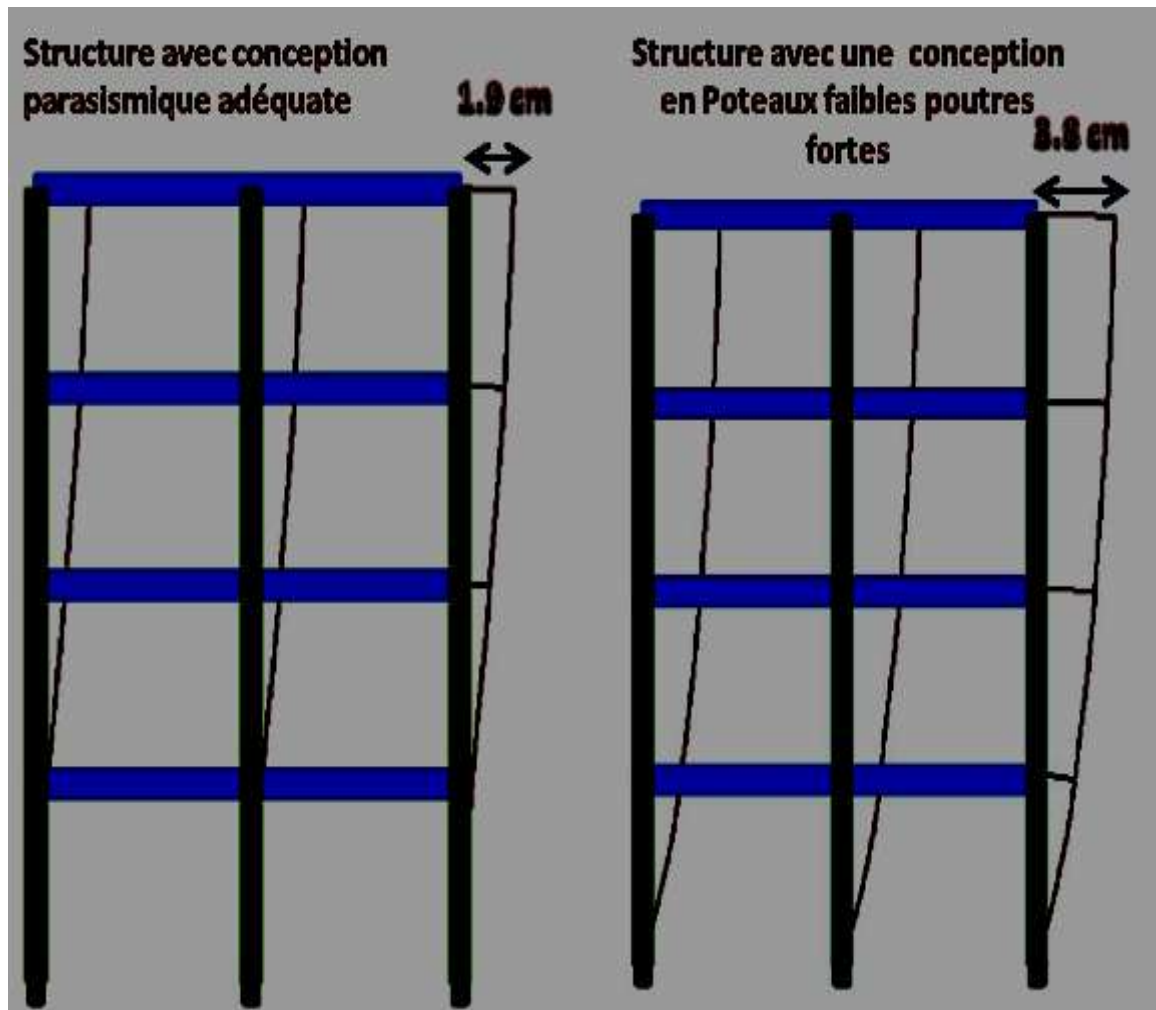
Déplacements entre étages de la structure encastree et de la structure avec une conception en poteaux faibles poutres fortes.
